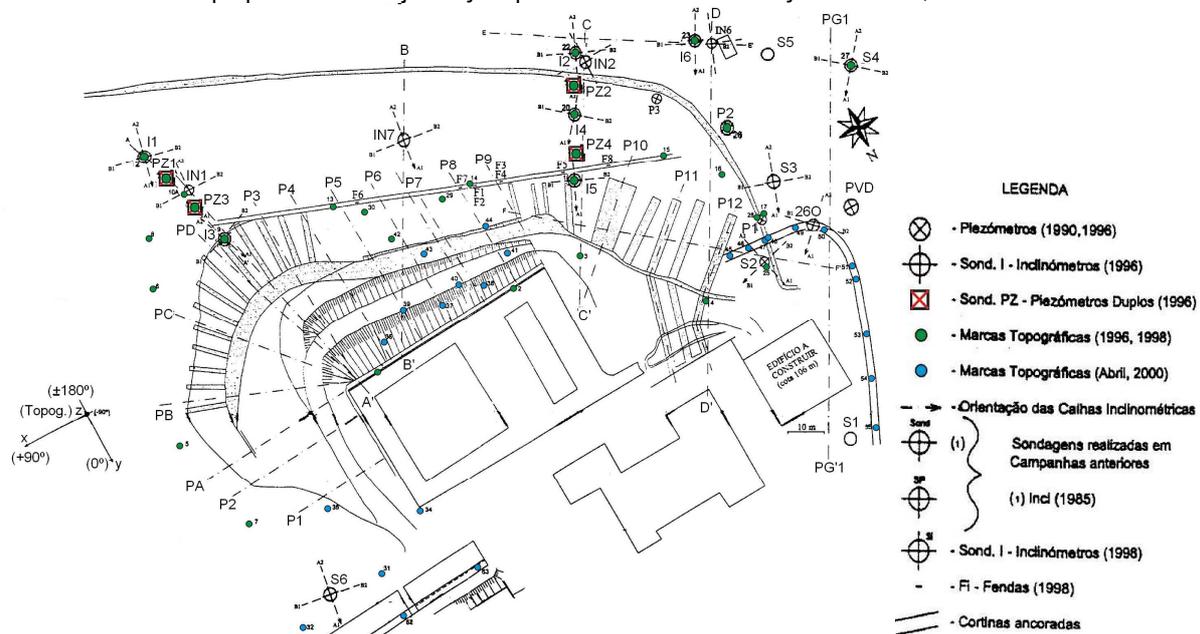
Planta de localização da instrumentação e das obras de reforço (zona central) da escola.
